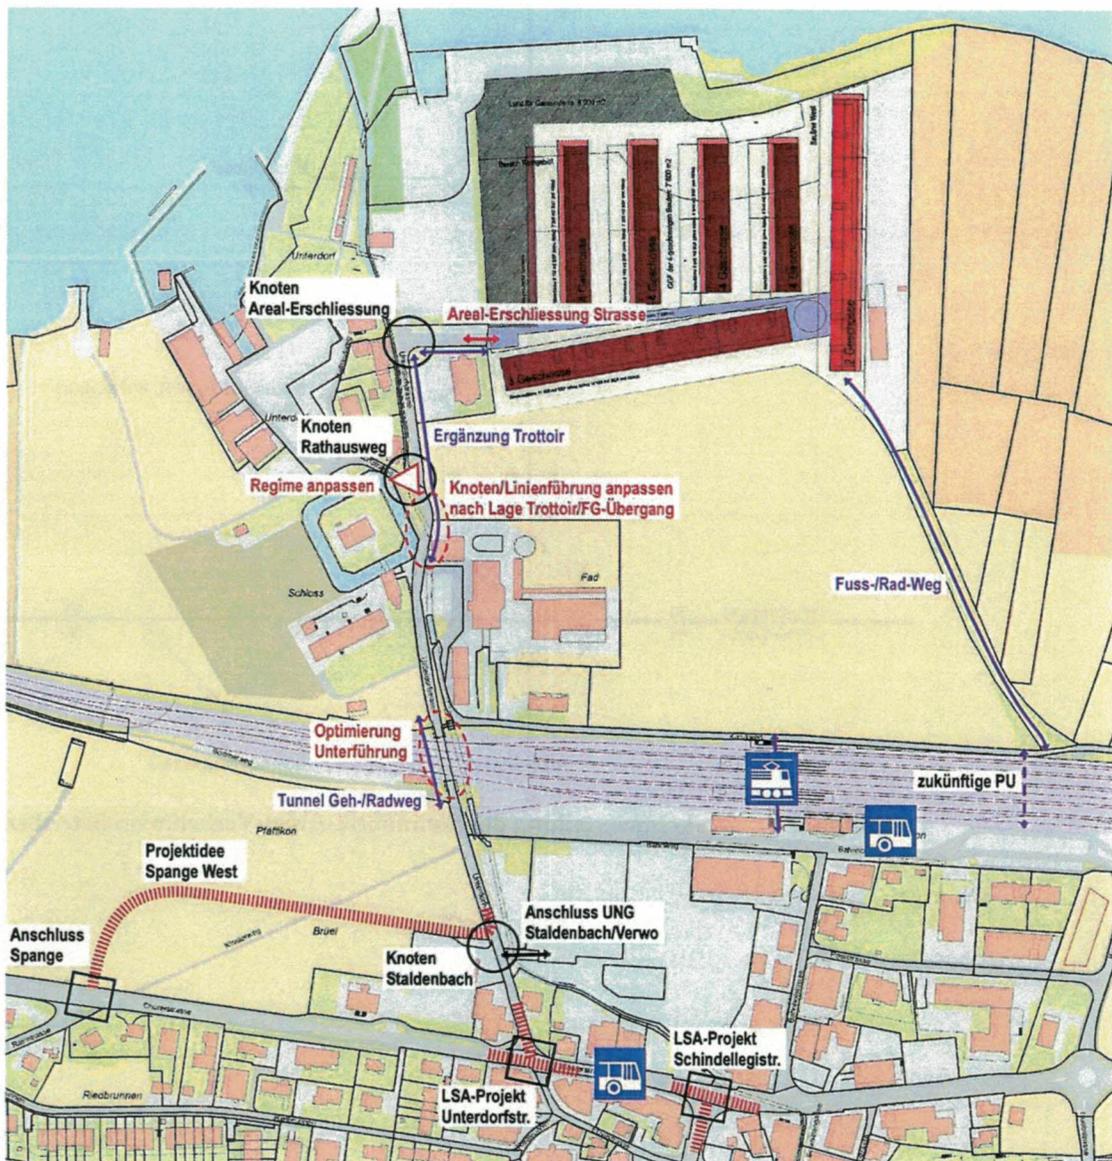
Übersichtsplan Erschliessungskonzept mit beeinflussenden Elementen
